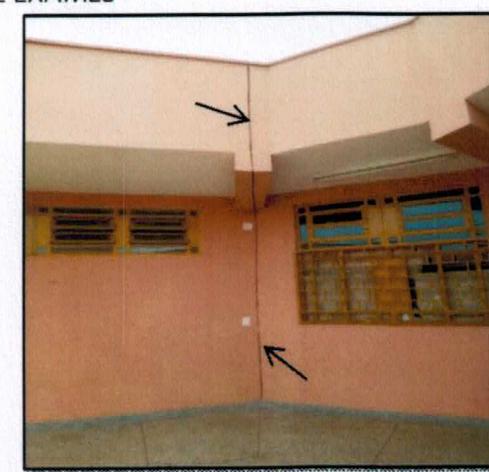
Foto da Fachada: Trinca no encontro entre blocos – ALAS A-B
